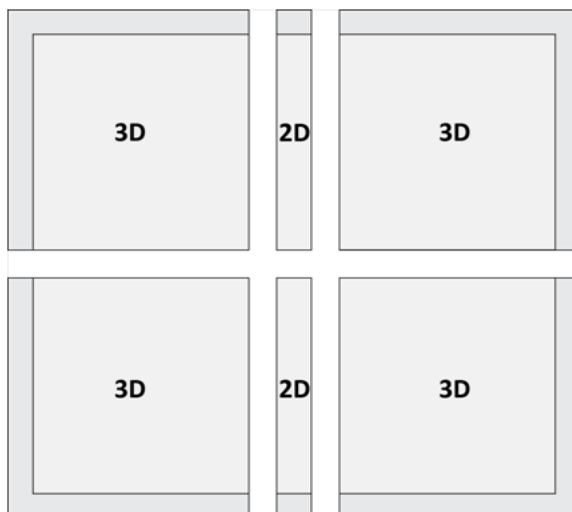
Berechnungsmodelle bei rechteckigem Gebäudegrundriss
